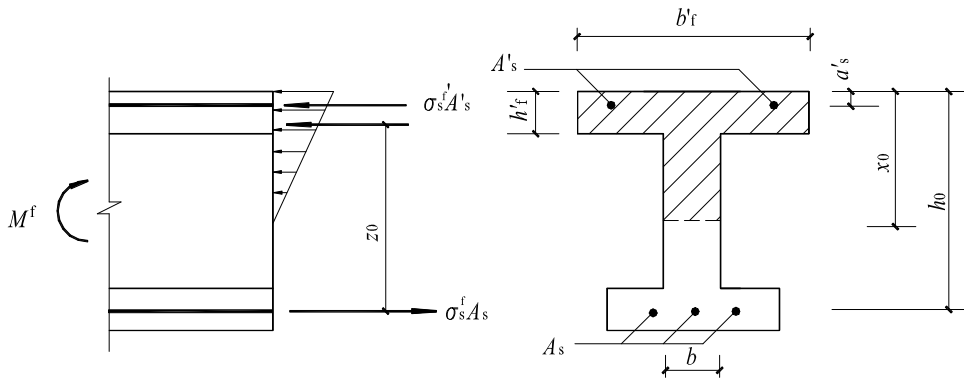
钢筋混凝土受弯构件正截面疲劳应力计算
